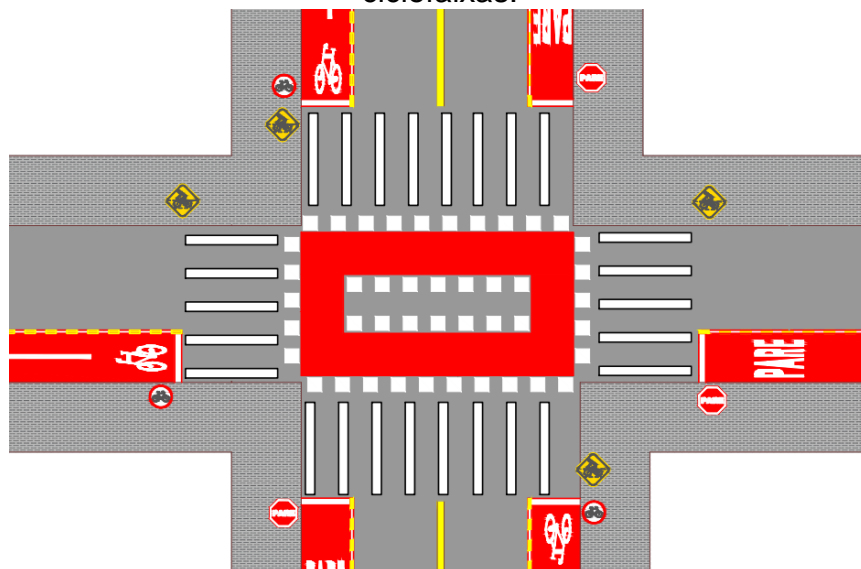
Exemplo de aplicação das sinalizações verticais para as ciclofaixas em cruzamentos.
